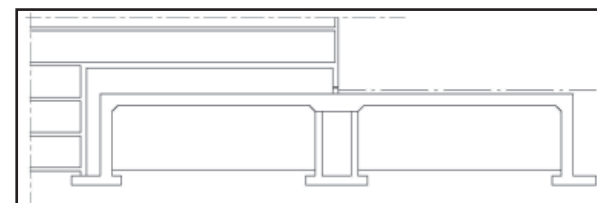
Tunnel med dubbelt tak, 2 tunnelrör
